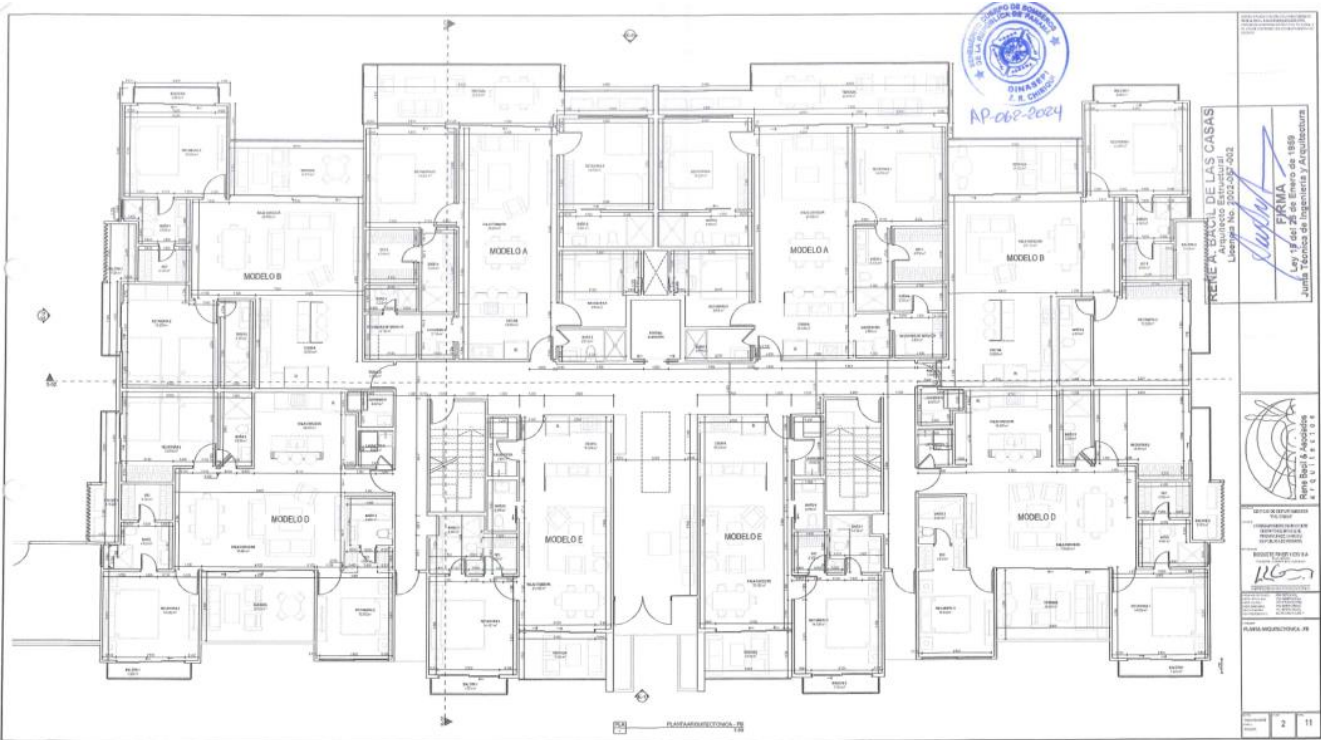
PLANTA BAJA “BOQUETE RIVER VIEW”
